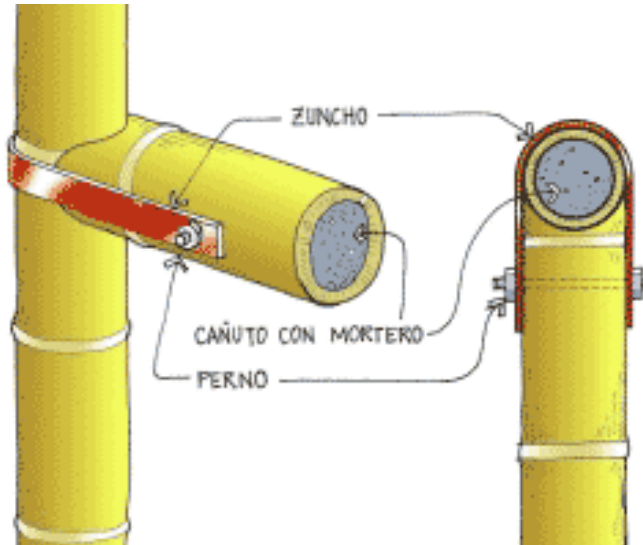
Las uniones zunchadas pueden utilizarse para fabricar conexiones articuladas.
